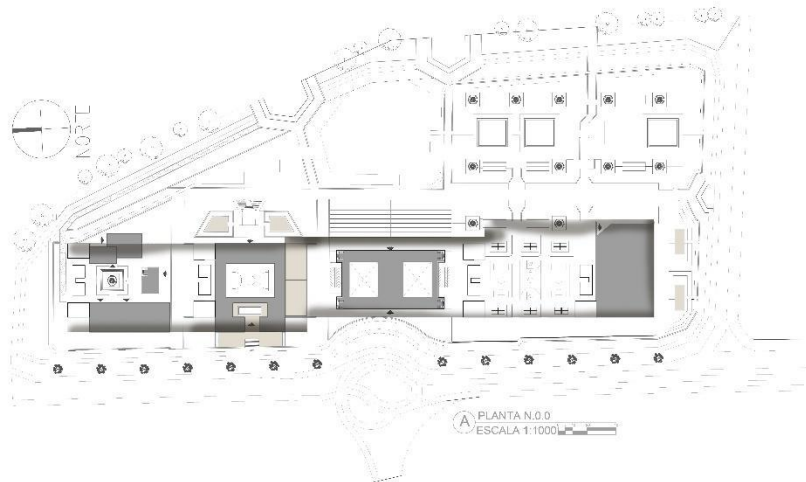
Equipamiento. Resalta el objeto arquitectónico en el parque. Elaboración propia
